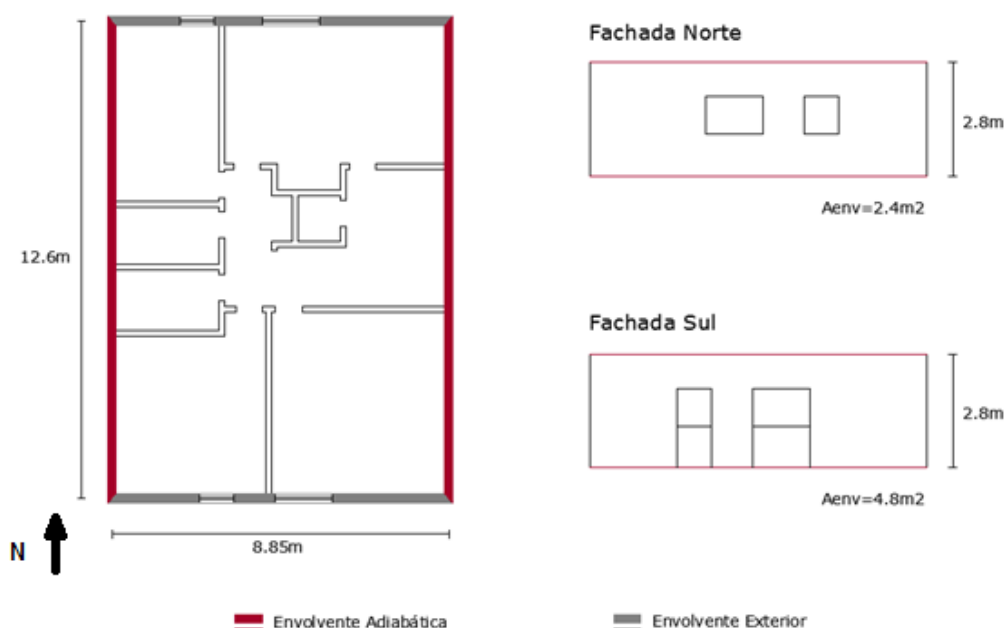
Planta e alçado Norte e Sul do modelo
